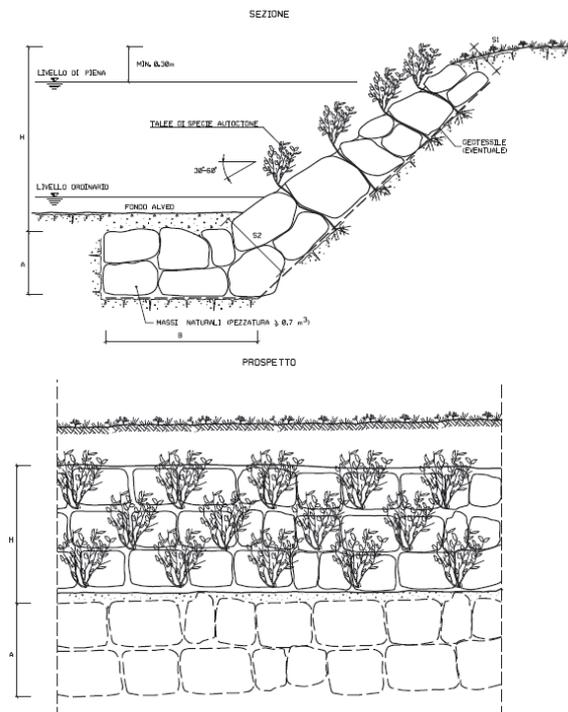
/A – Sezione trasversale e prospetto della scogliera in massi (disegno standard)
